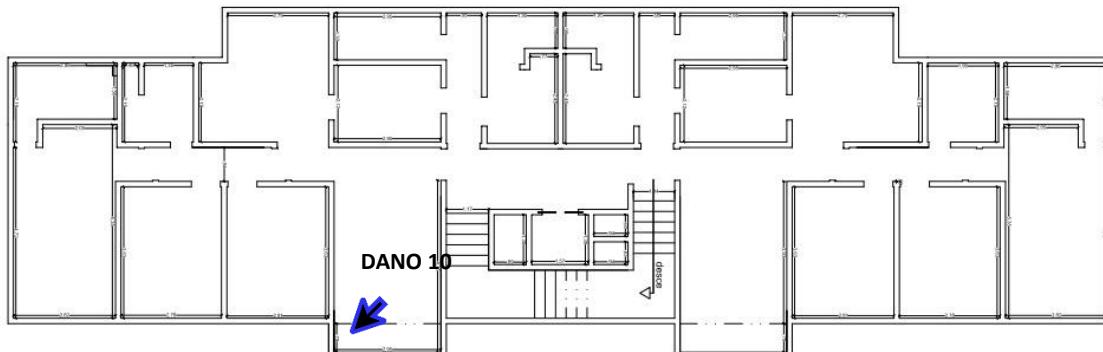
Planta Baixa (croqui) – Pavimento do 2º andar – Bloco B – Cond. Armando Lôbo.
